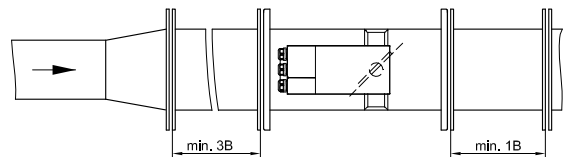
Einbau nach Störstelle, z.B. Aufweitung
